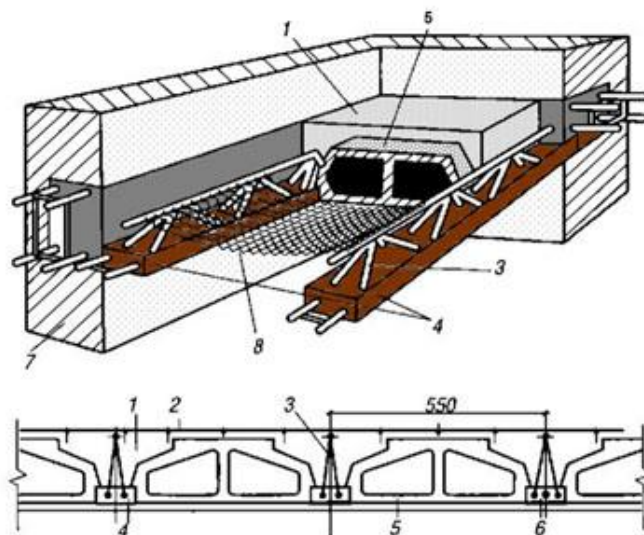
Фрагмент збірно-монолітного перекриття із порожнистих бетонних блоків
